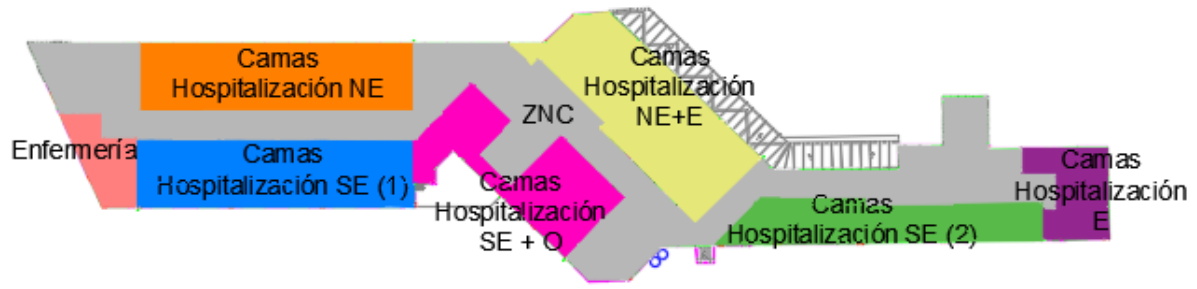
Anexo I. Zonificación planta 3 (fuente: elaboración propia).
